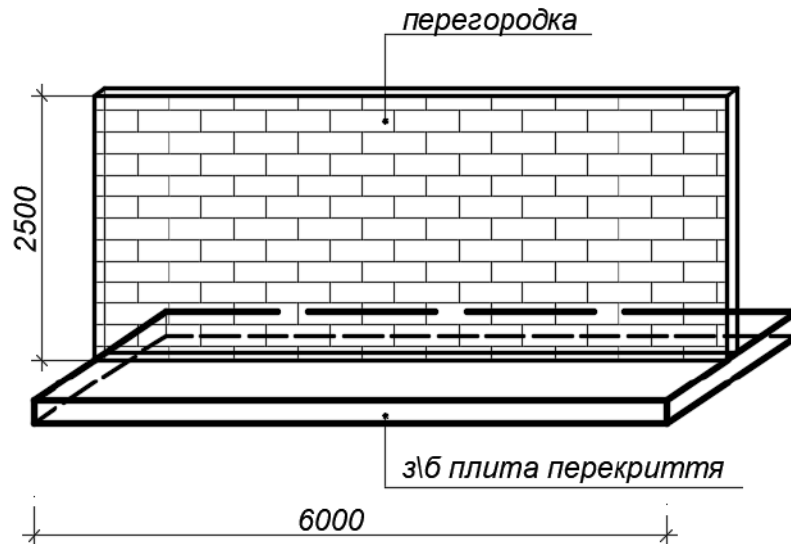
Перегородка, яка розташована уздовж збірної з/б плити перекриття
